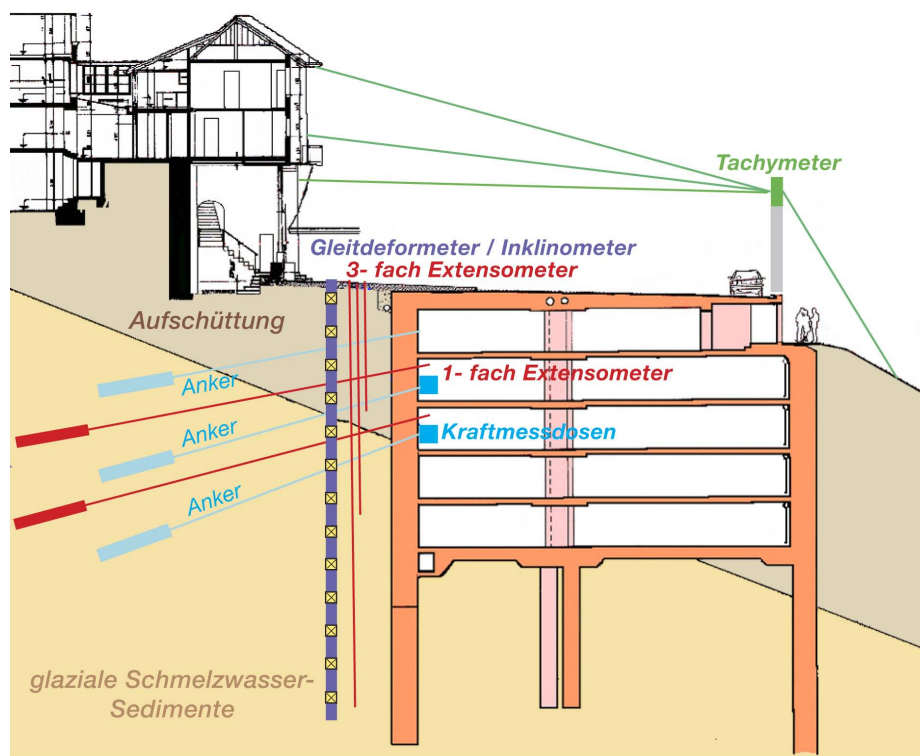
Querschnitt der Erweiterung des Rathausparking mit Instrumentierung
